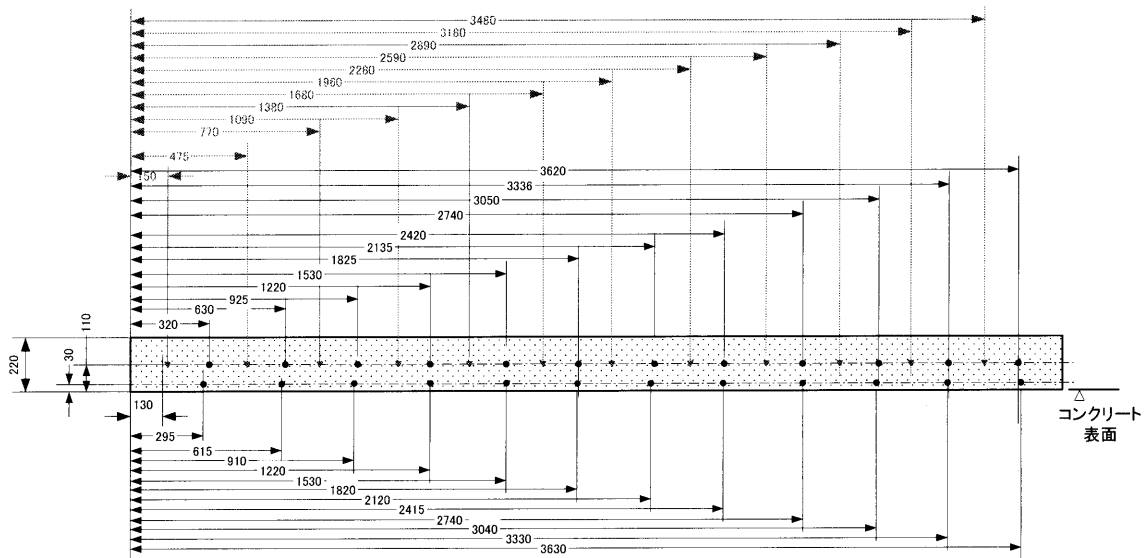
供試体① 側面 A 側 鉄筋位置
